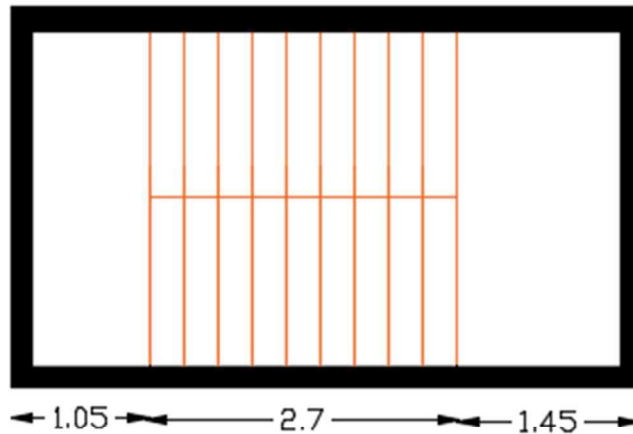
Vue en plan d'un escalier droit à deux volées
